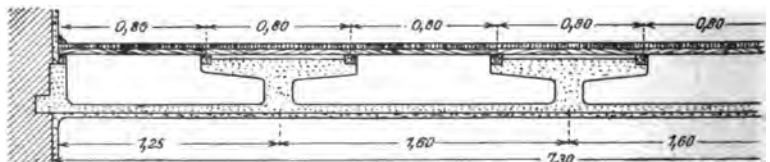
Schallsichere Eisenbetondecke von R. Kaczor.
